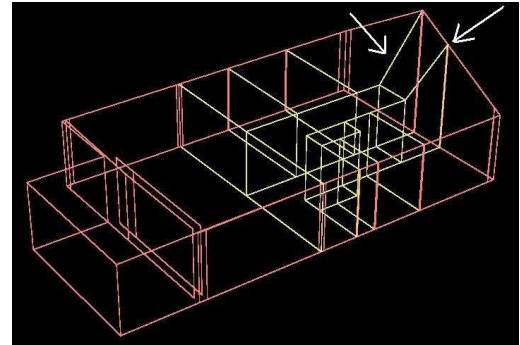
Problème de raccordement au toit des parois intérieures
